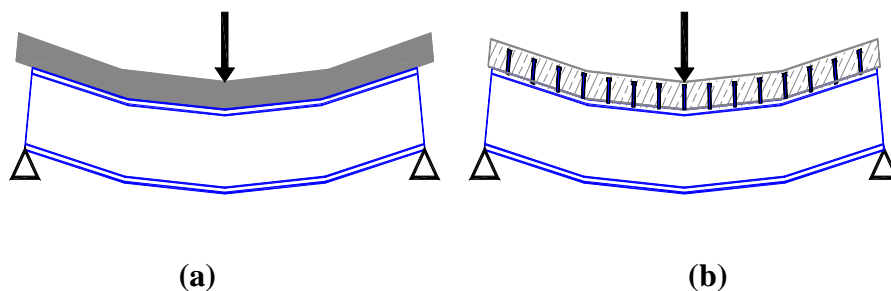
(a): Poutre non mixte, (b): et poutre mixte (b) [13].
